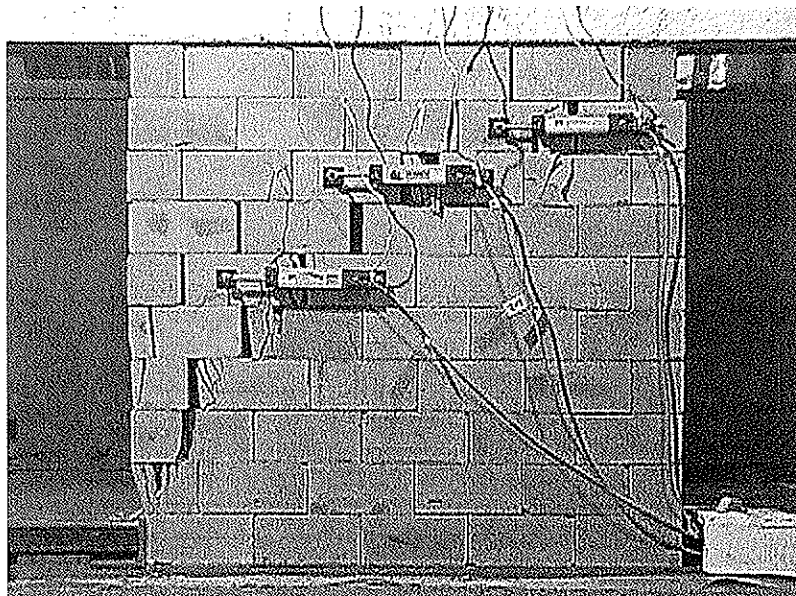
Ejemplo de muro de bloques de piedra a junta seca ensayado en laboratorio.
